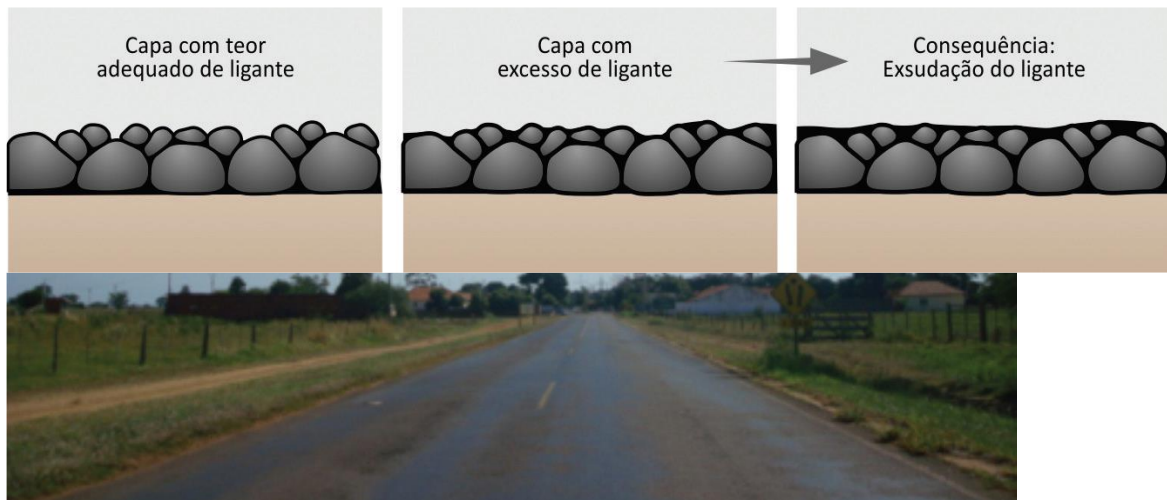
Exsudação na camada superficial de um pavimento (DER/SP, 2012)
